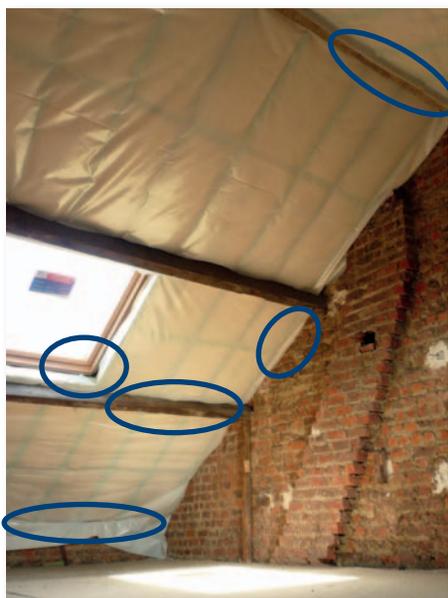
Étanchéité à l'air insuffisante de la toiture dans une maison mitoyenne en raison d'un mauvais traitement des raccords
